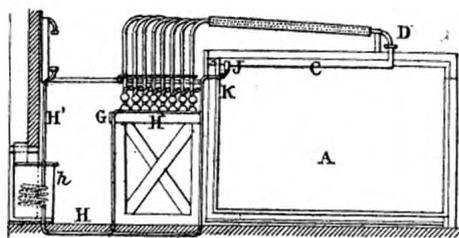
Perkins. Ensemble d'un grand appareil.
